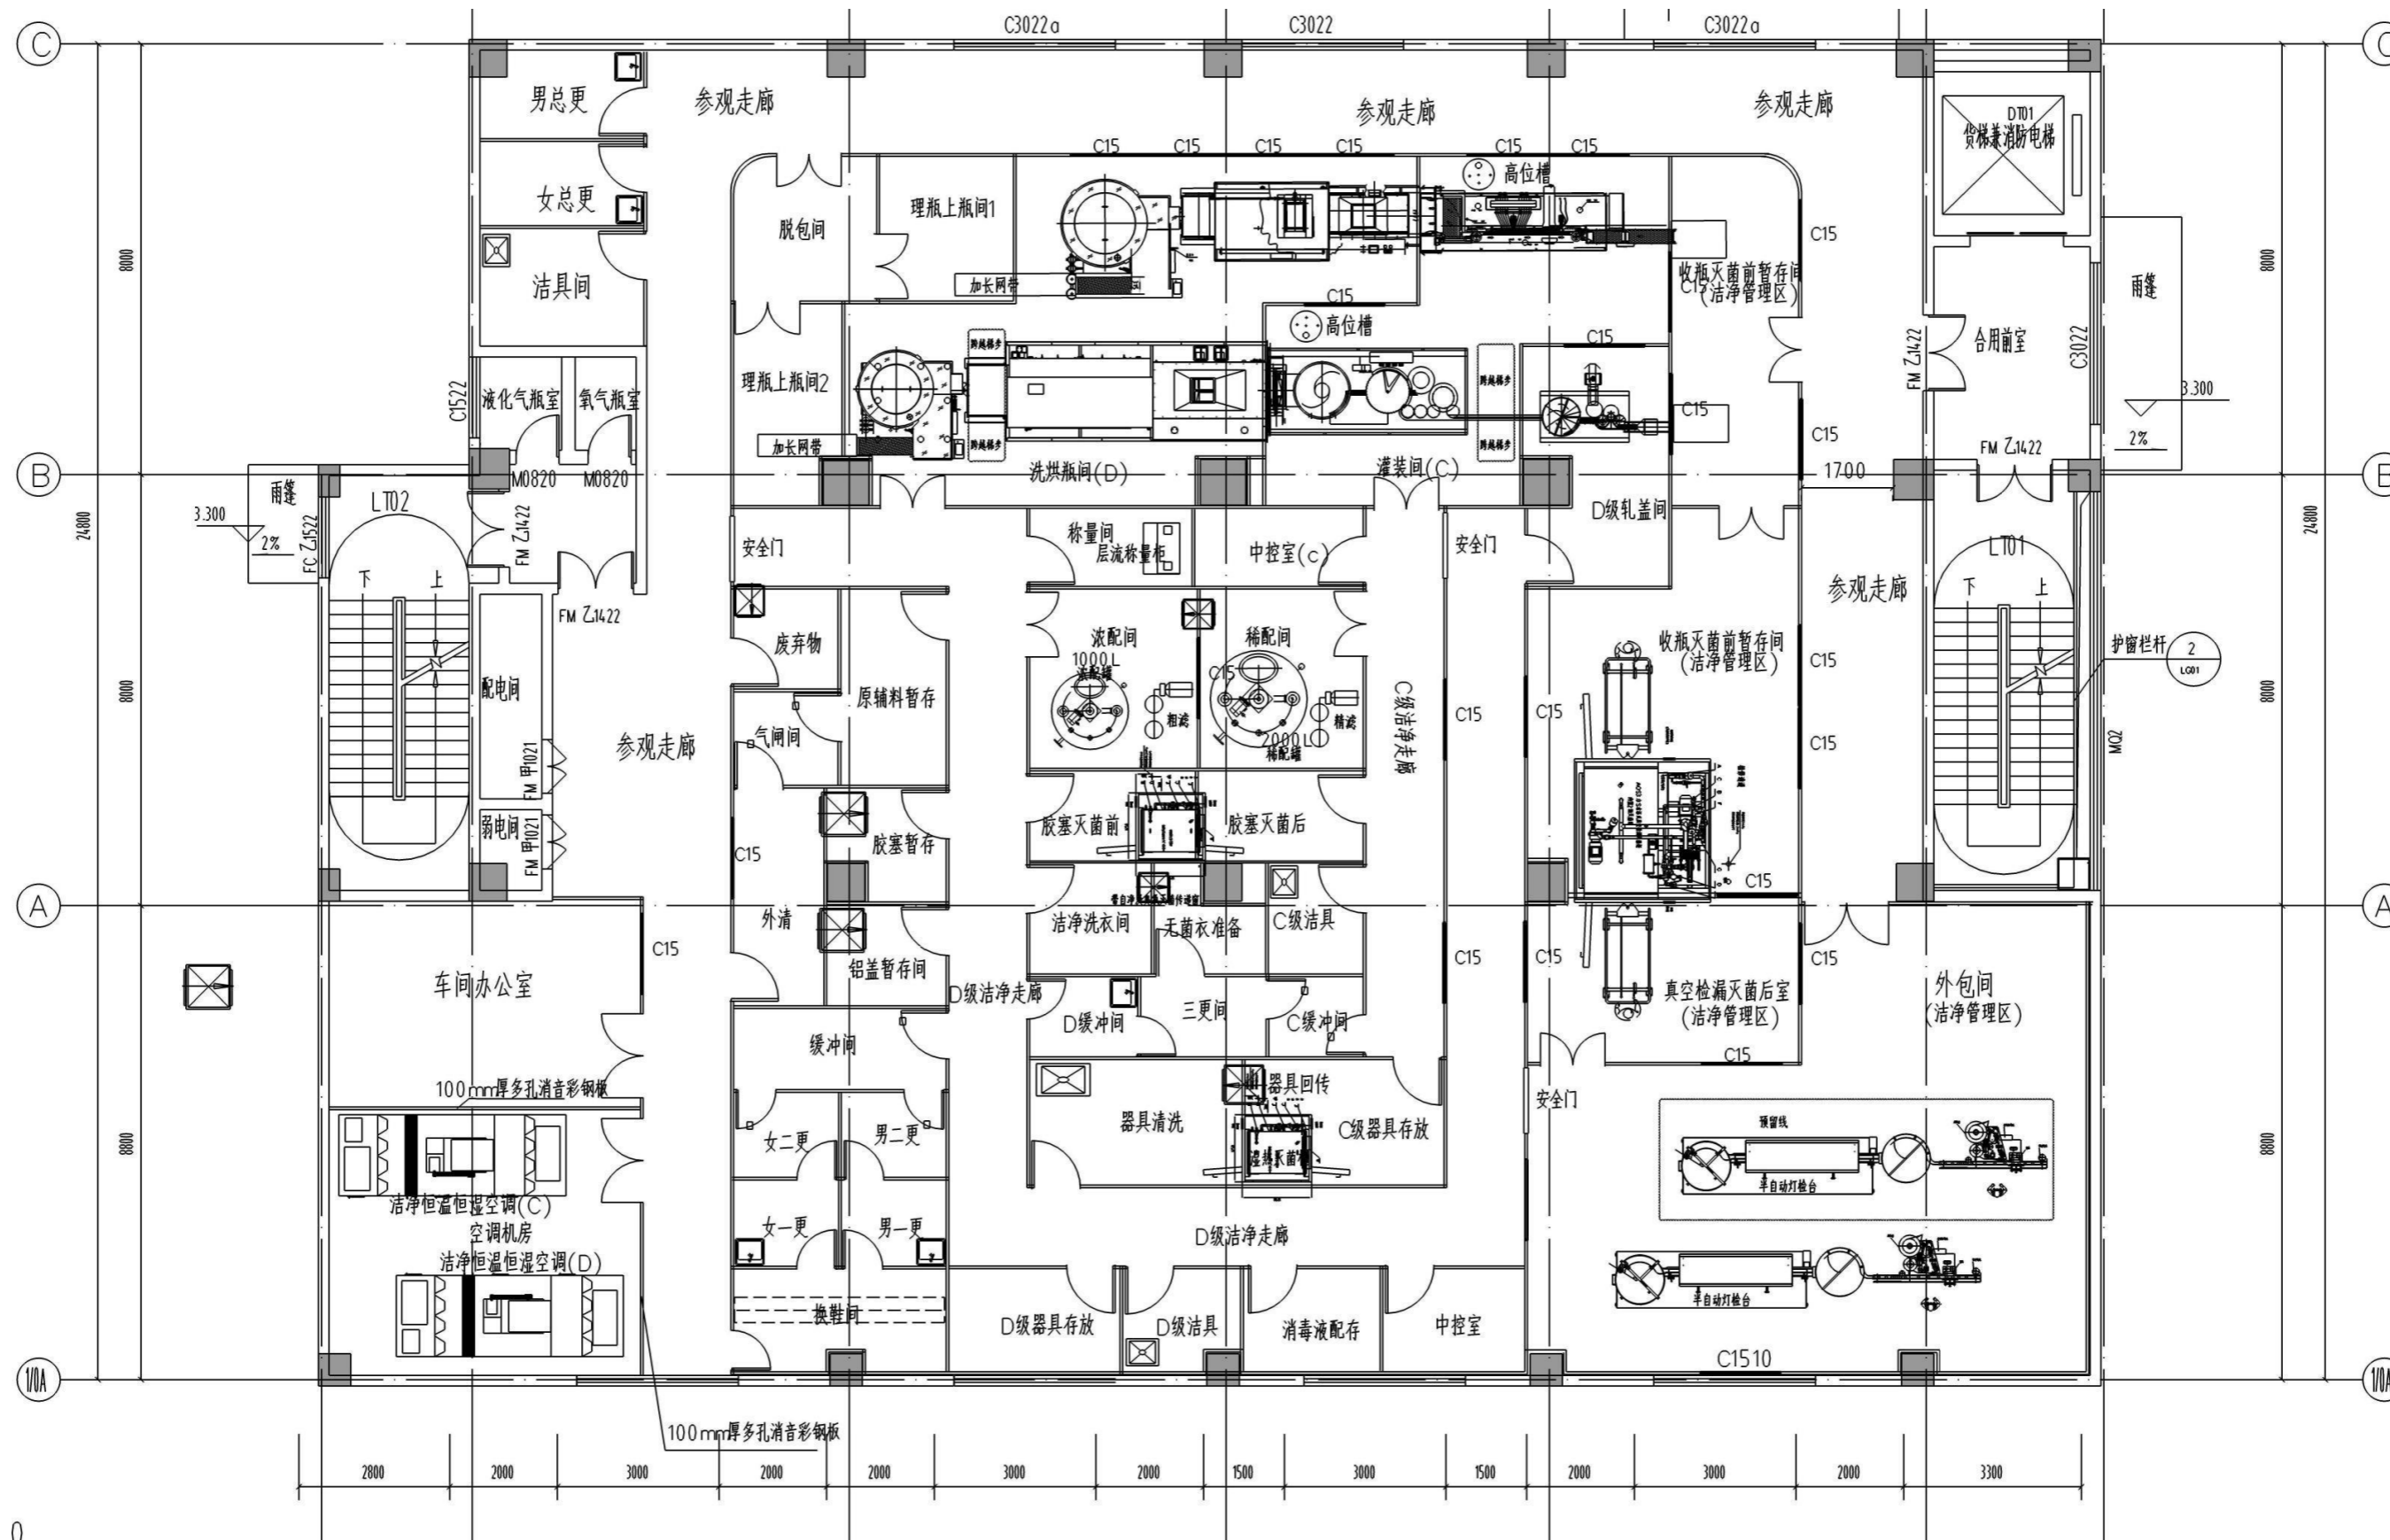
二层（注射剂车间）平面布置图（比例尺 1:100）
